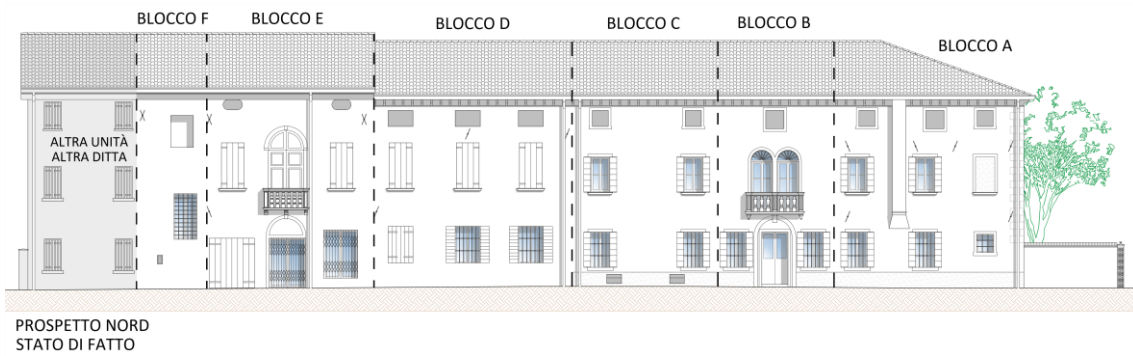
Prospetto Nord - Stato di fatto – scala generica
